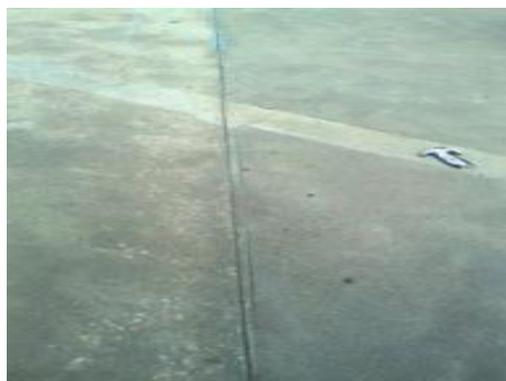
Pavimento em betão com junta colmatada - Loures
